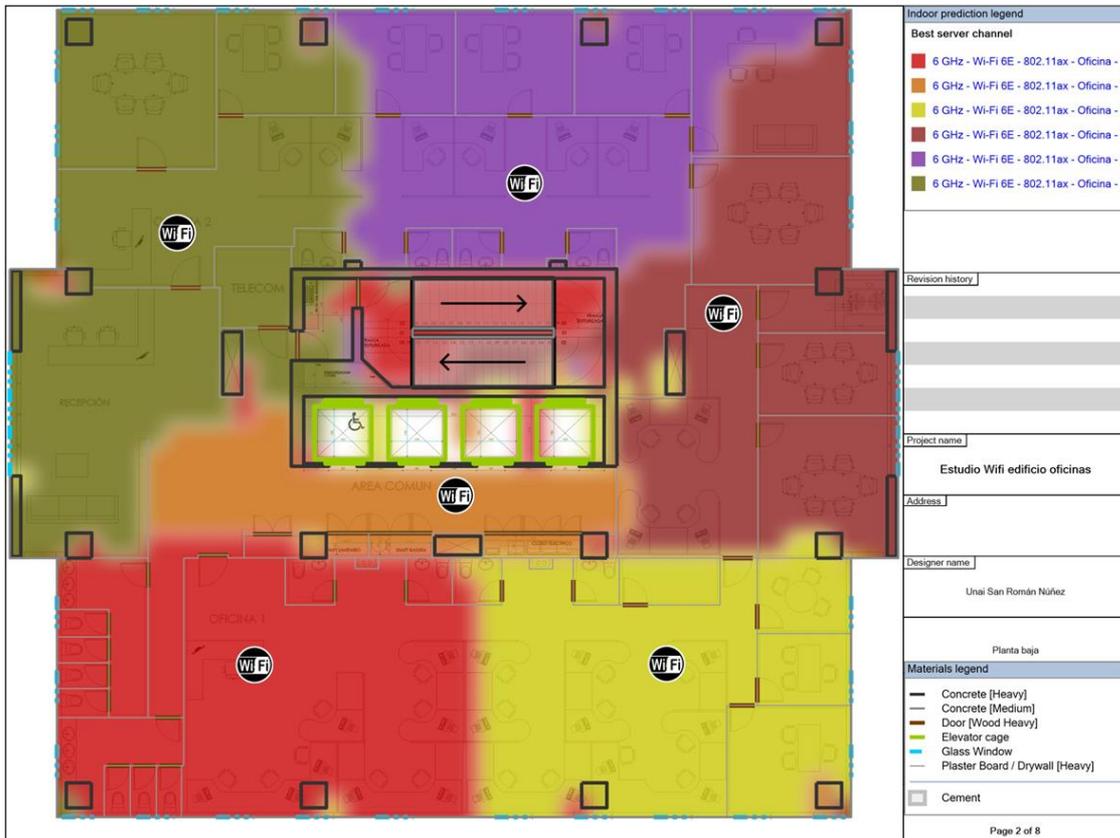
Mejor Servidor de AP 6Ghz. Planta baja.
